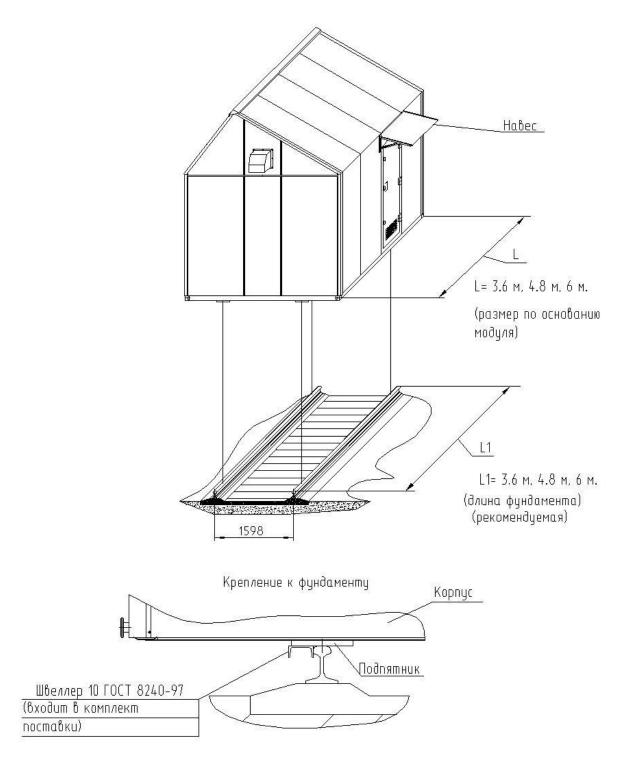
Установка корпусов на типовые фундаменты. Установка на рельсошпальную решетку.
